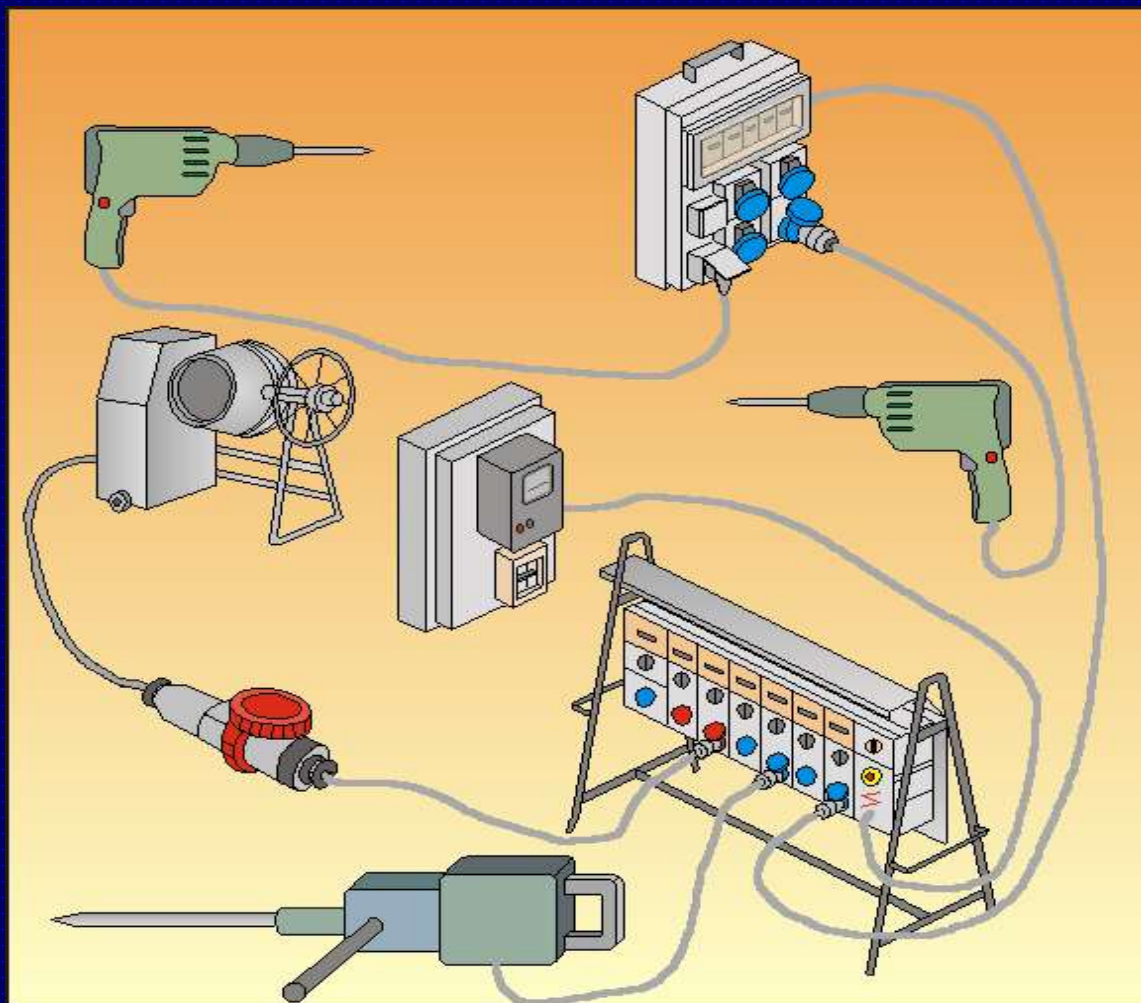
Nei piccolissimi cantieri l'alimentazione del quadretto di prese a spina da cantiere può essere derivata direttamente dalla presa a spina dell'impianto esistente.
